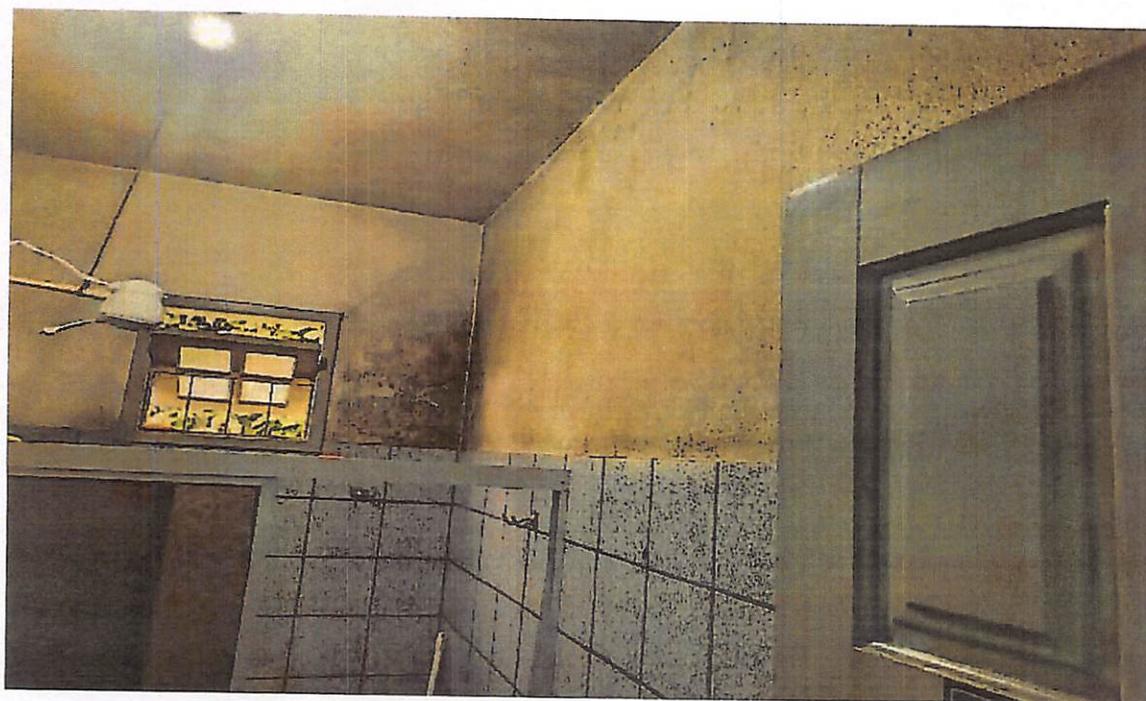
Vista do banheiro com azulejo até 1,80 m e restante com reboco e emassamento. Indícios de mofo nas paredes.
